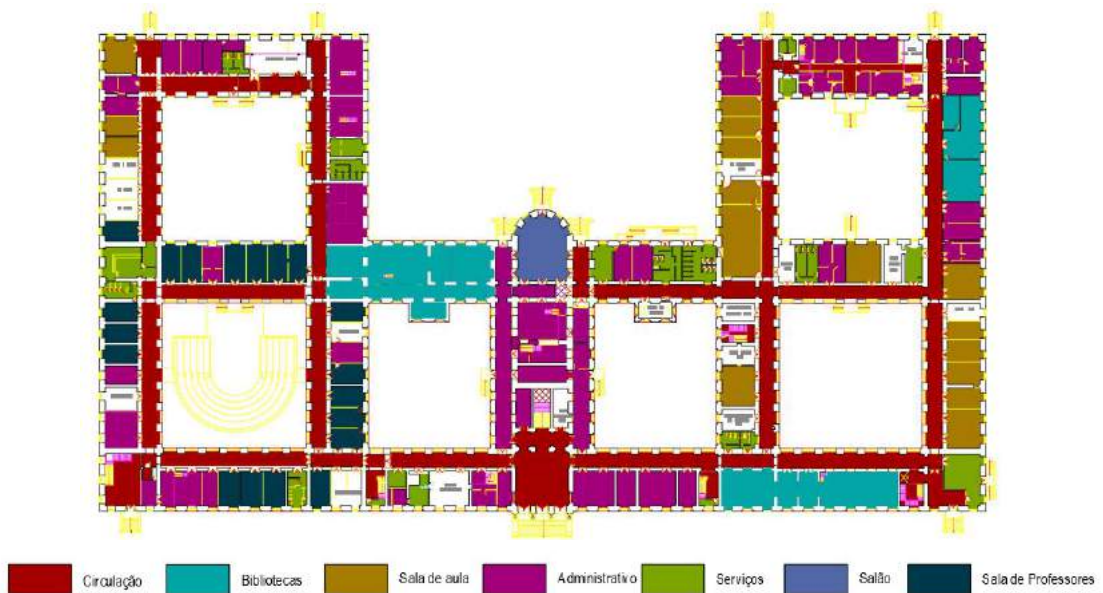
Planta de Uso do 1º Pavimento do Palácio universitário /UFRJ
